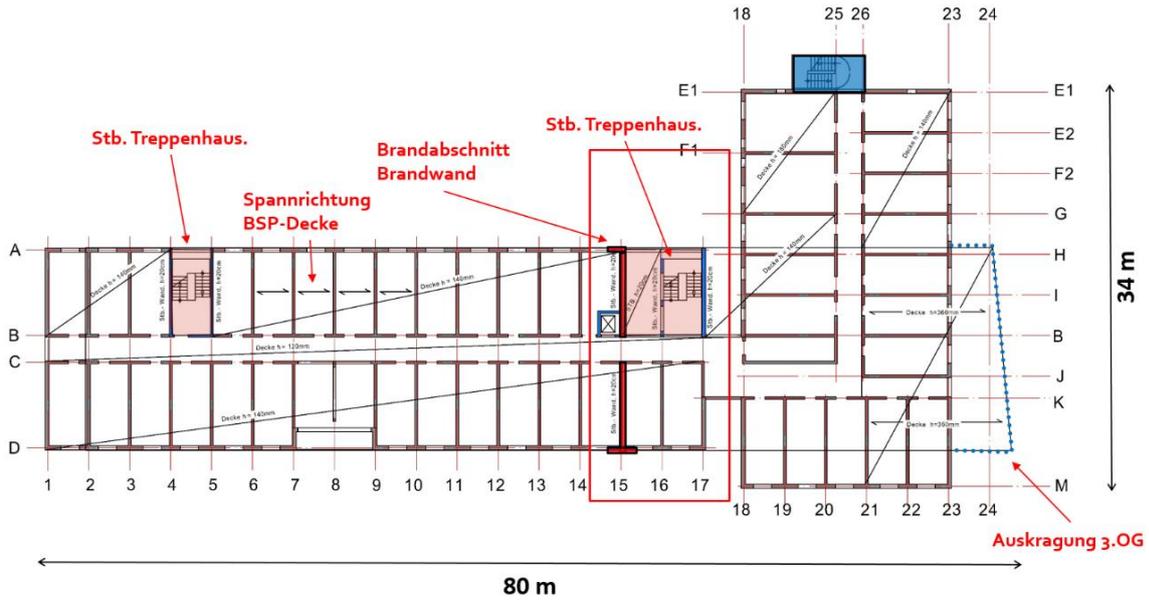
Grundriss Alfter [Knevels & Röttgen]
